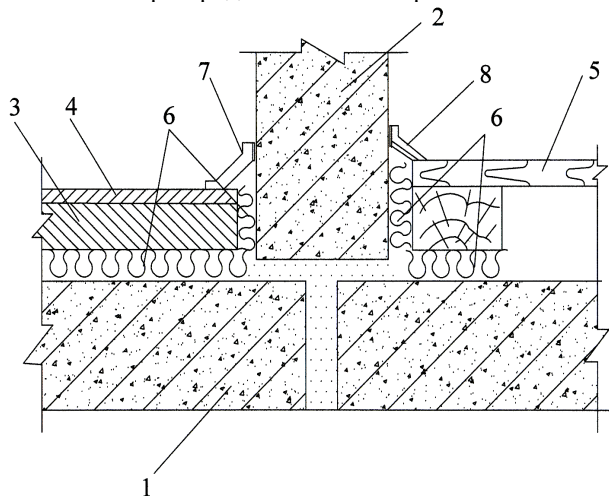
Схема конструктивного решения узла примыкания пола на звукоизоляционном слое к стене (перегородке).
